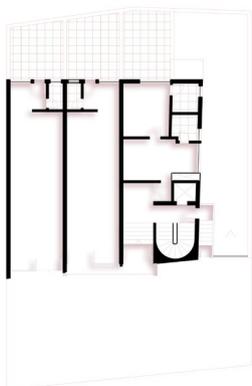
Edifício Condado de Luzerne, pavimento térreo.
